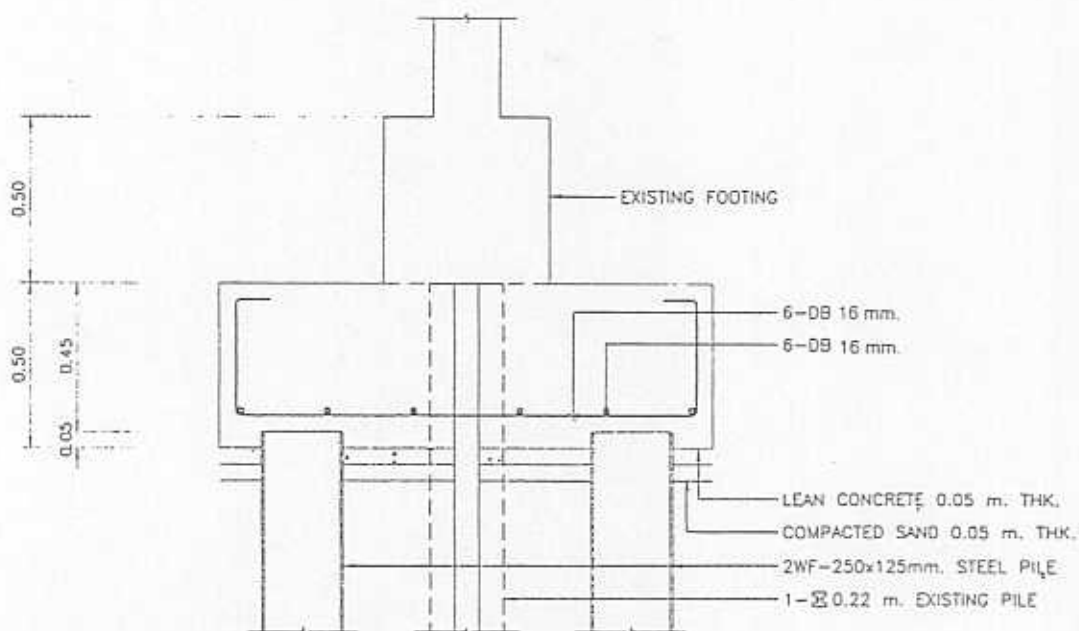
แผนแปลนเสาเข็มและฐานรากอาคาร "บ้านสวน" (Foundation and Pier Plan of "Ban Suan" House)
